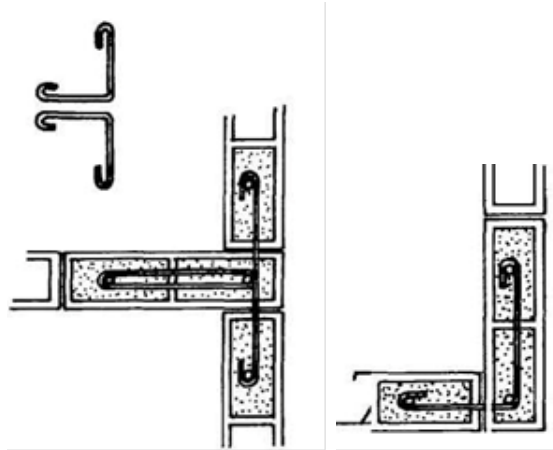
Detalle del supe de refuerzo horizontal en el encuentro de muros (Moas, 1993)
